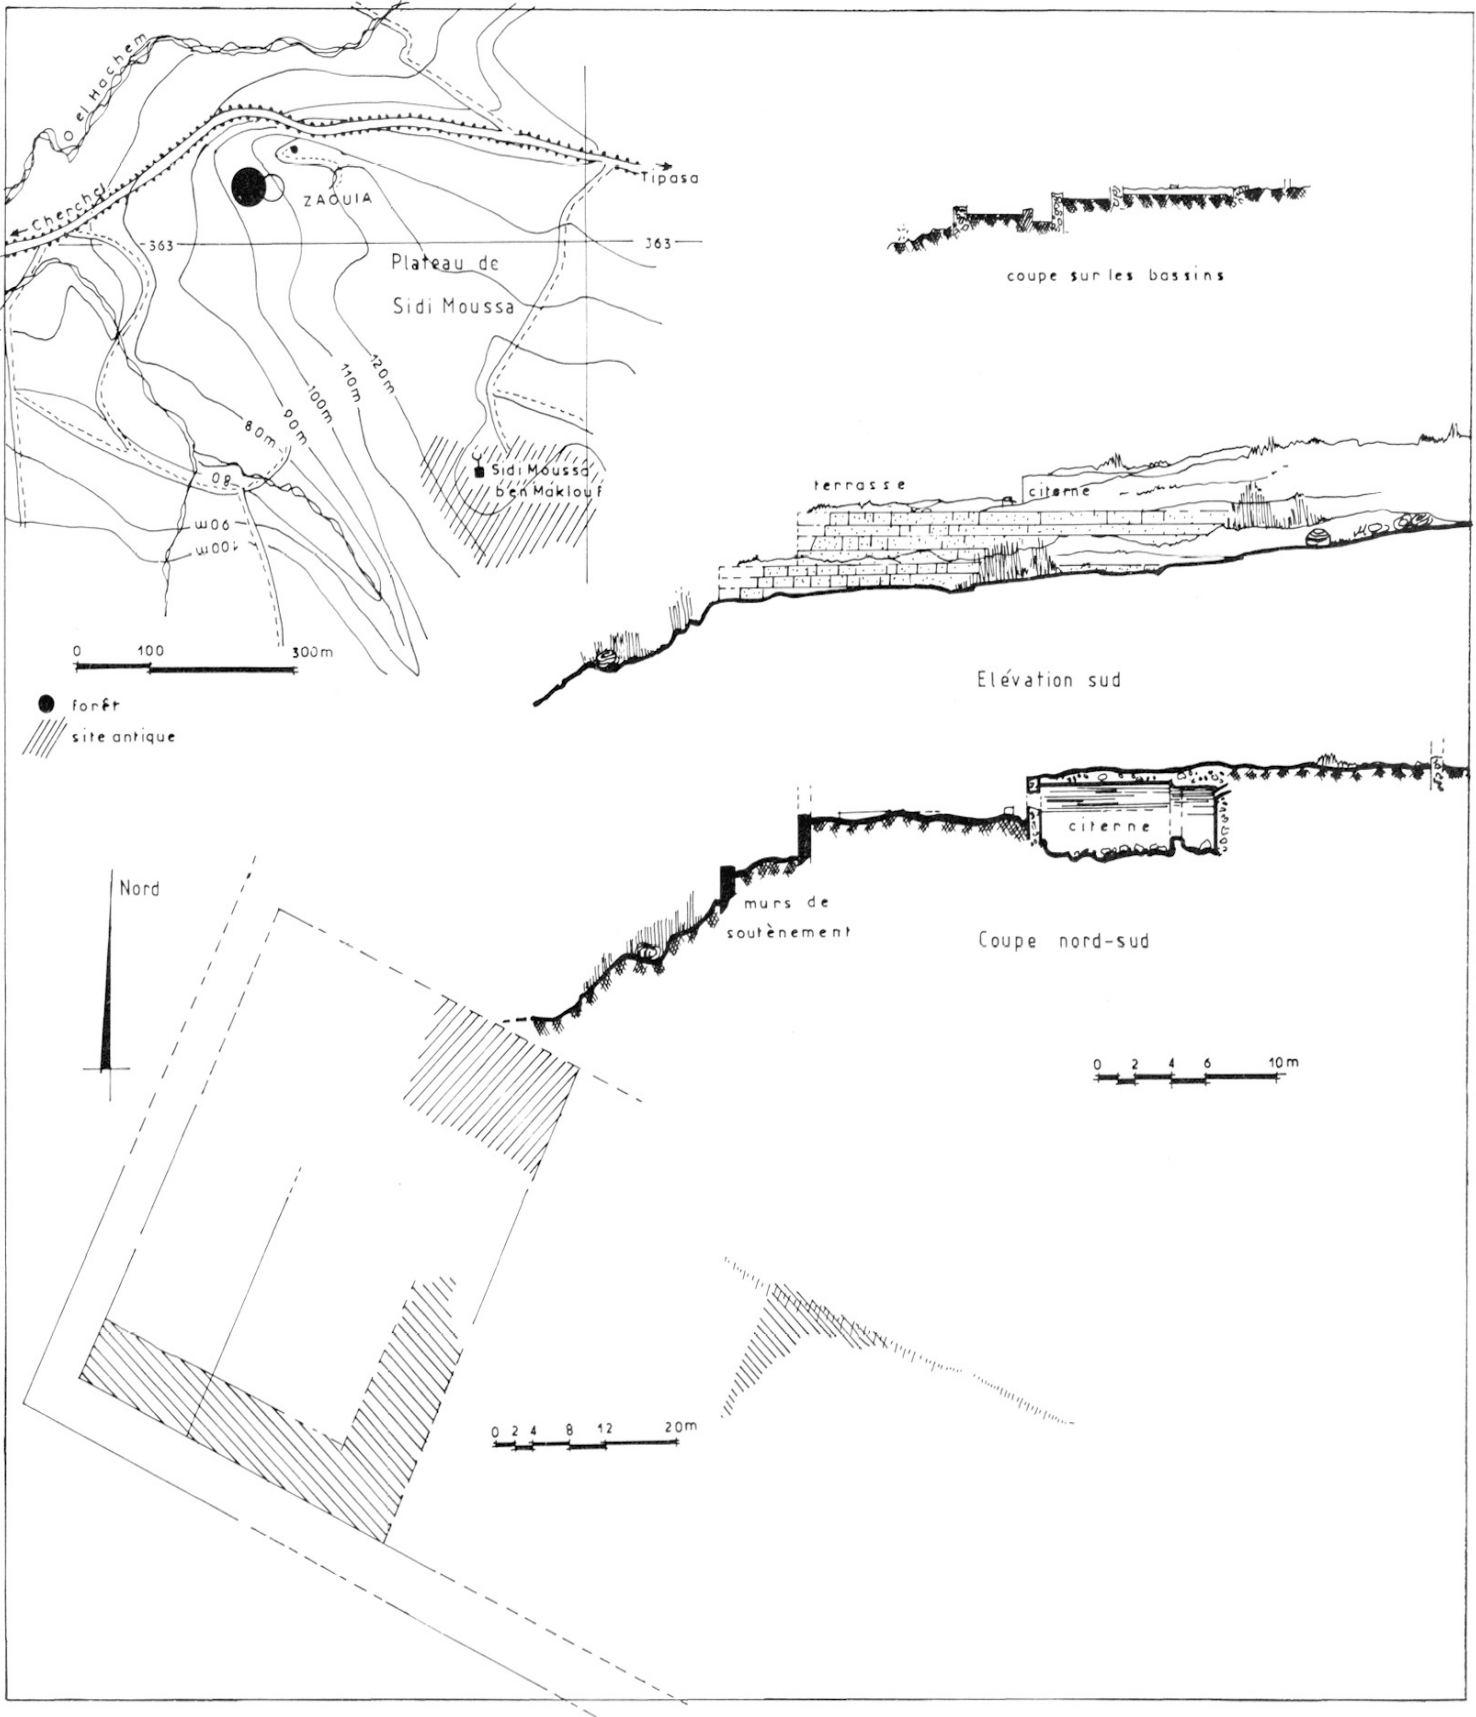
Id. : croquis de situation, coupes et plan de masse restitué.
